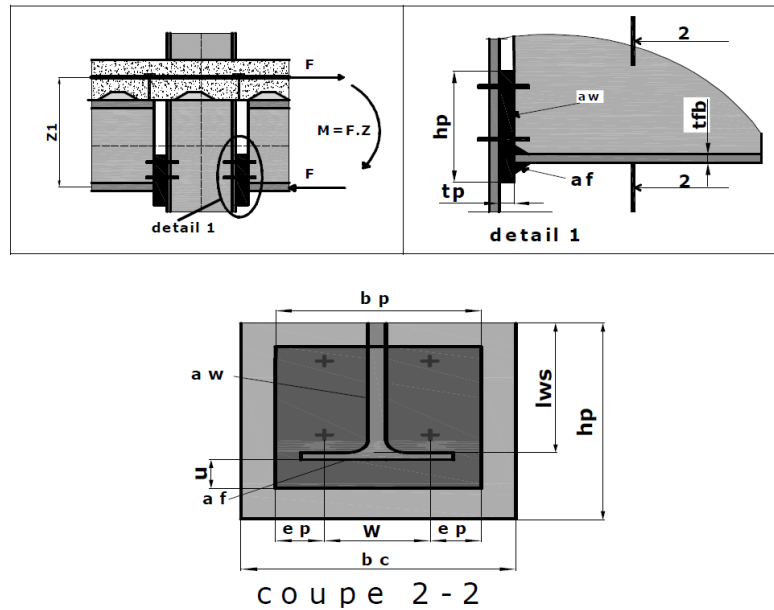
Caractéristiques géométriques d'un Assemblage poutre-poteau par platine d'extrémité de hauteur limitée
